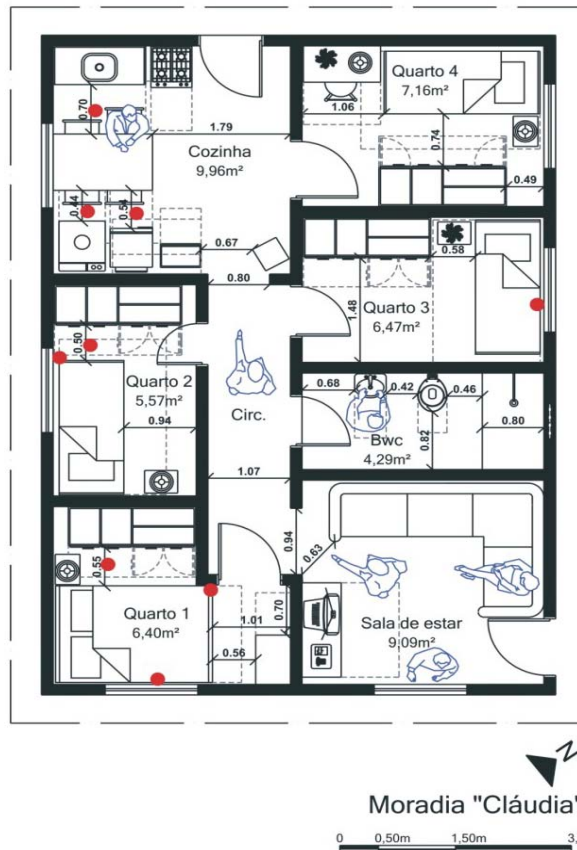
Exemplo da análise dimensional do estudo em planta baixa
